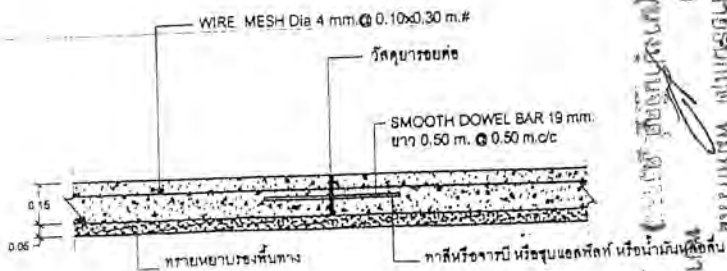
DETAIL: CONSTRUCTION JOINT (รอยต่อเพื่อการก่อสร้าง)
